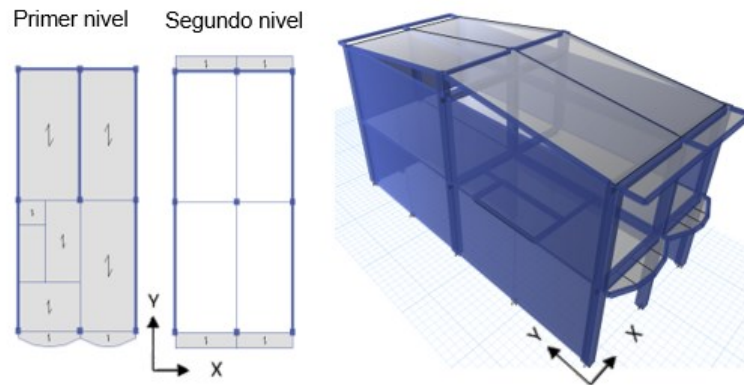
Vista en planta y 3D, tipología GII(2P) – ETABS.
